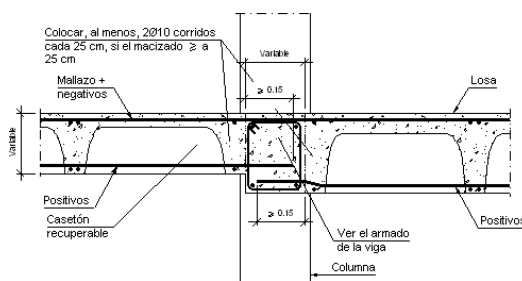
Detalle de Losa Reticular. Fuente: <http://detallesconstructivos.mx.cype.com/EHR623.html> (2017).
